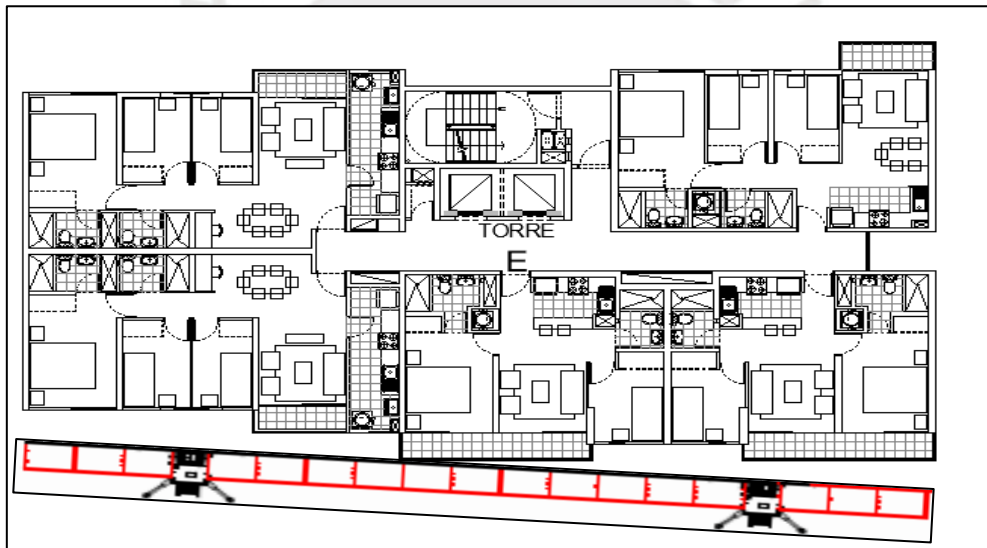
Esquema posición bimástil fachada Av. Santa Callao
